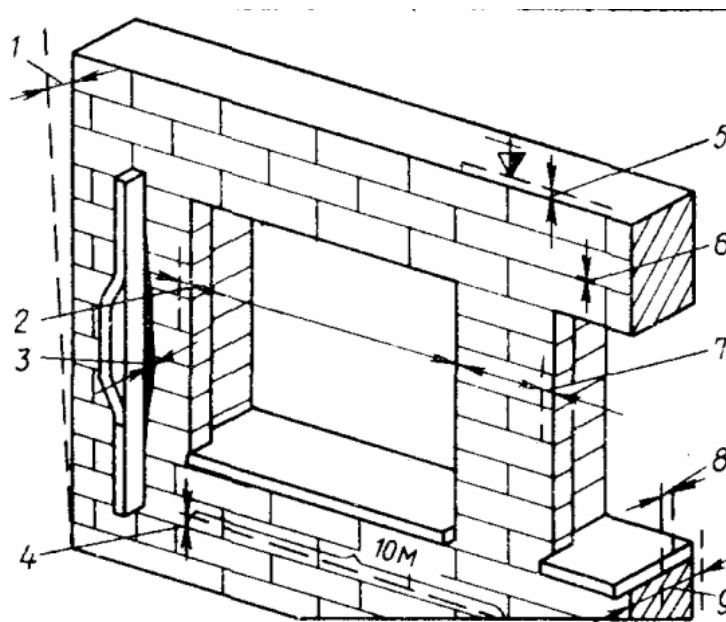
Схема допусков кирпичной кладки
